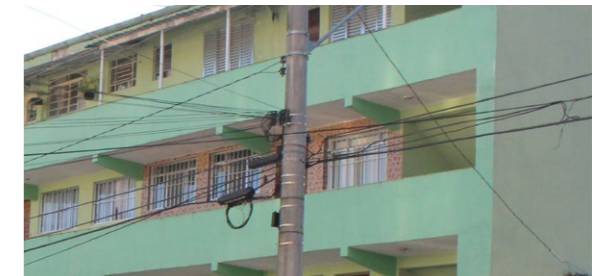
revestimento cerâmico aplicado na fachada correspondente a uma unidade habitacional.
